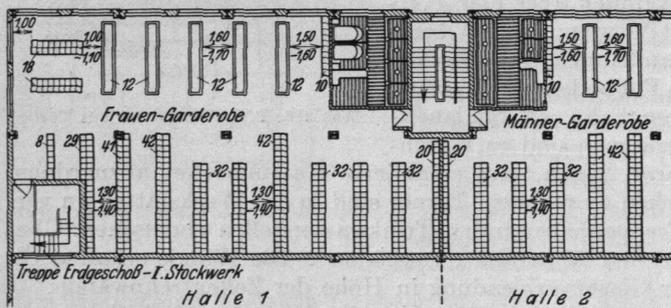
Arbeiter-Garderobenanlage im 1. Stockwerk eines mehrgeschossigen Hallenkopfbaues.
